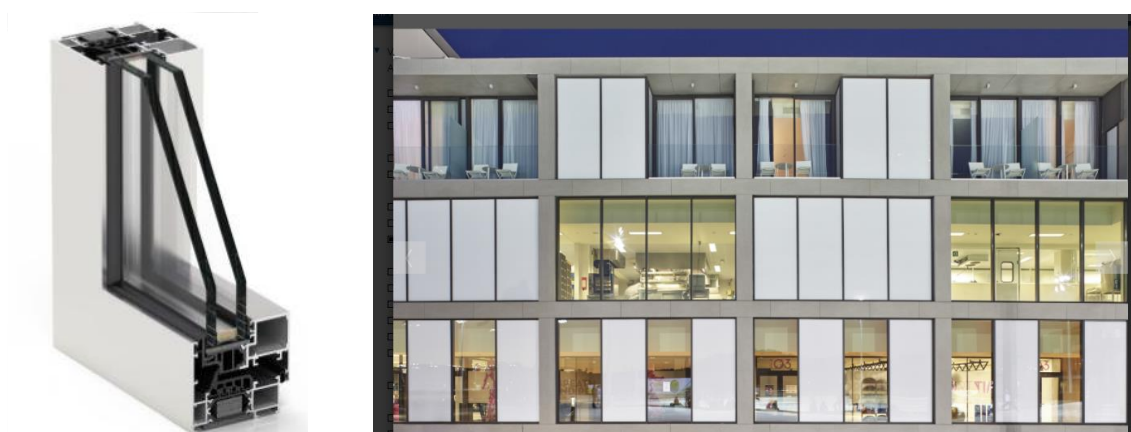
A la izquierda detalle de la carpintería Sistema Cor-70 de "CORTIZO" y a la derecha detalle de la fachada de la Rafa Nadal Academy en Manacor donde se ha instalado este modelo. Fuente: CORTIZO
